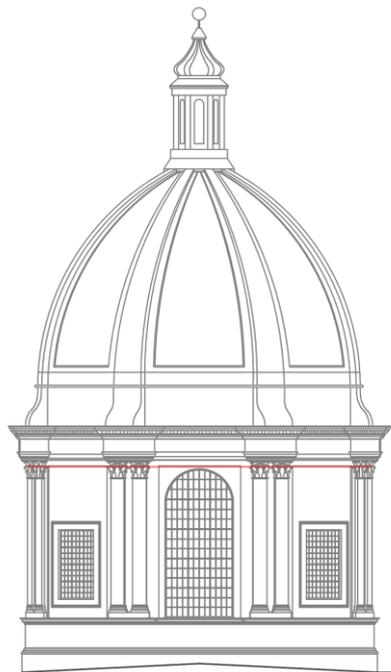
Prospetto cupola/tamburo con evidenziazione del cerchiaggio inferiore.
